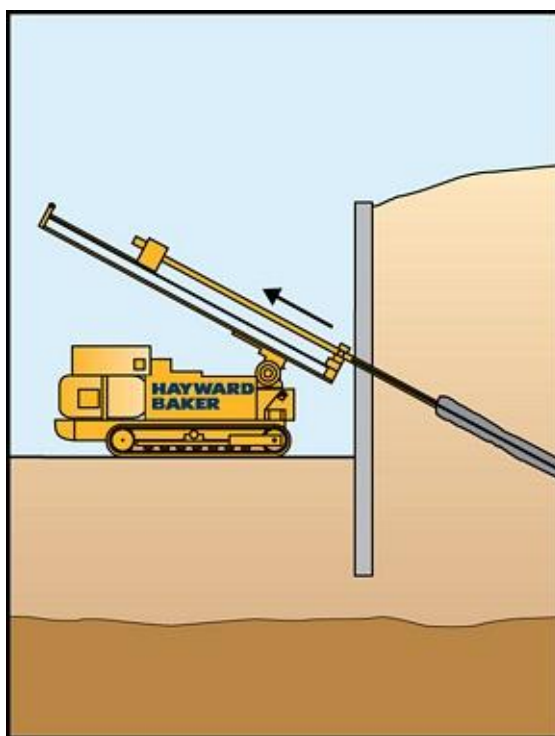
Ilustração de um muro de contenção ancorado (retirado de www.haywardbaker.com)
